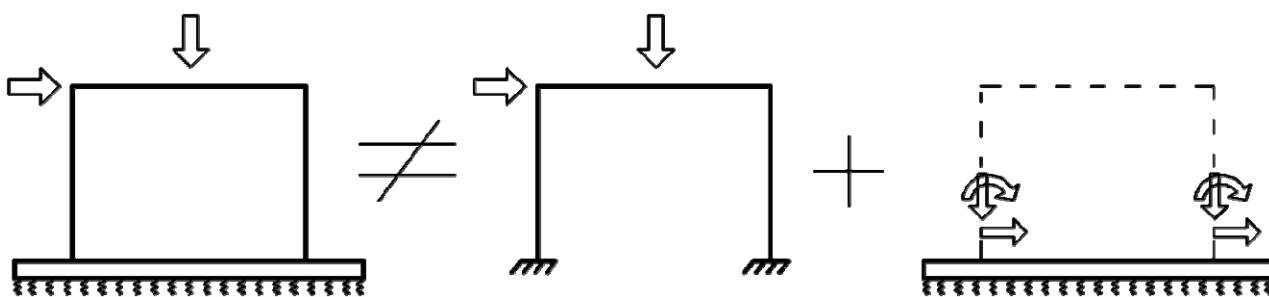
Учет совместной работы «надземное строение – фундаментная плита – грунтовое основание»
